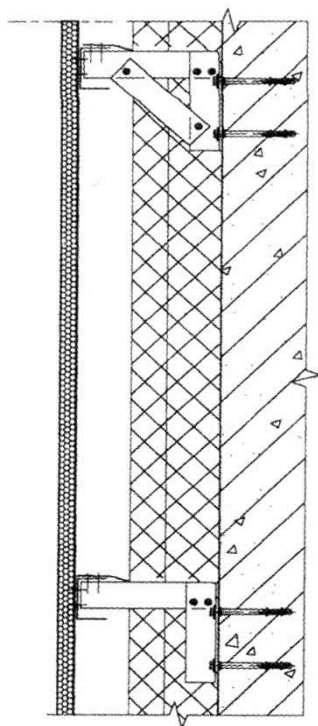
Конструкция теплоэффективной конструкции стены с вентилируемой воздушной прослойкой (вентилируемый фасад)
